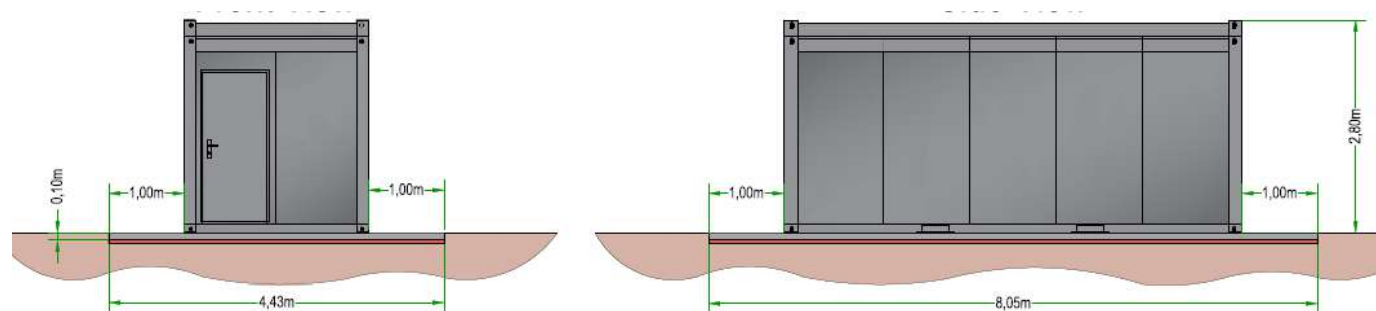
Vues de profil et de face du conteneur prévu sur site (source : BayWa r.e.)
